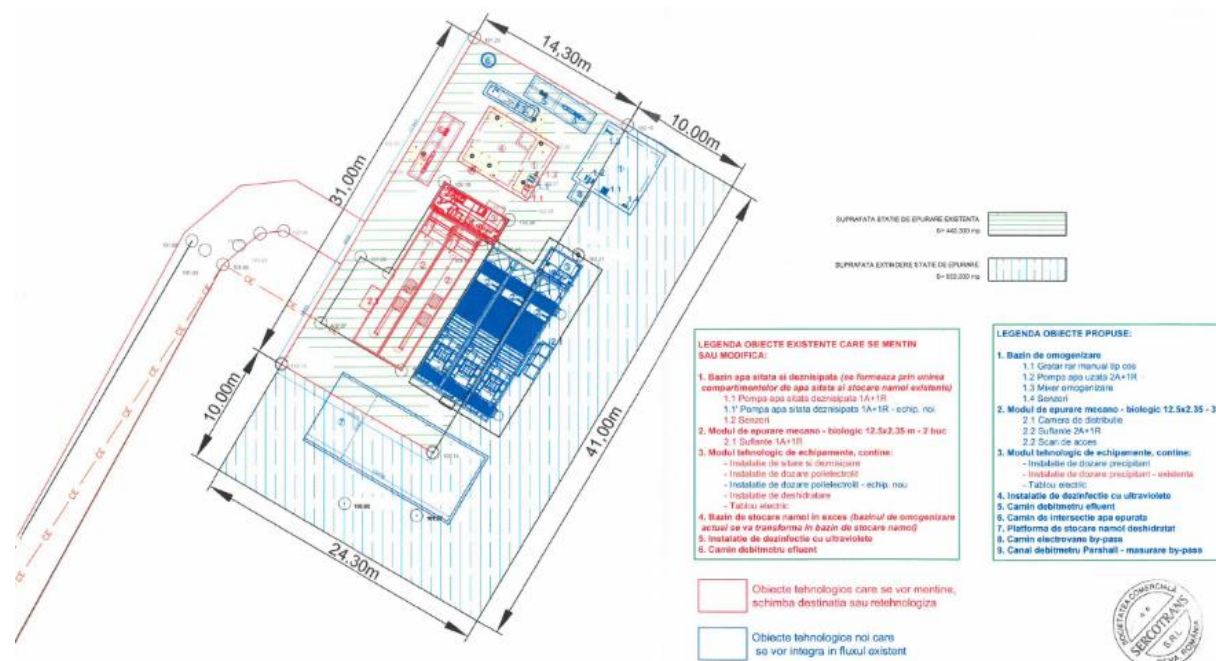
Plan de situatie statia de epurare Vinga – lucrari existente si propuse
